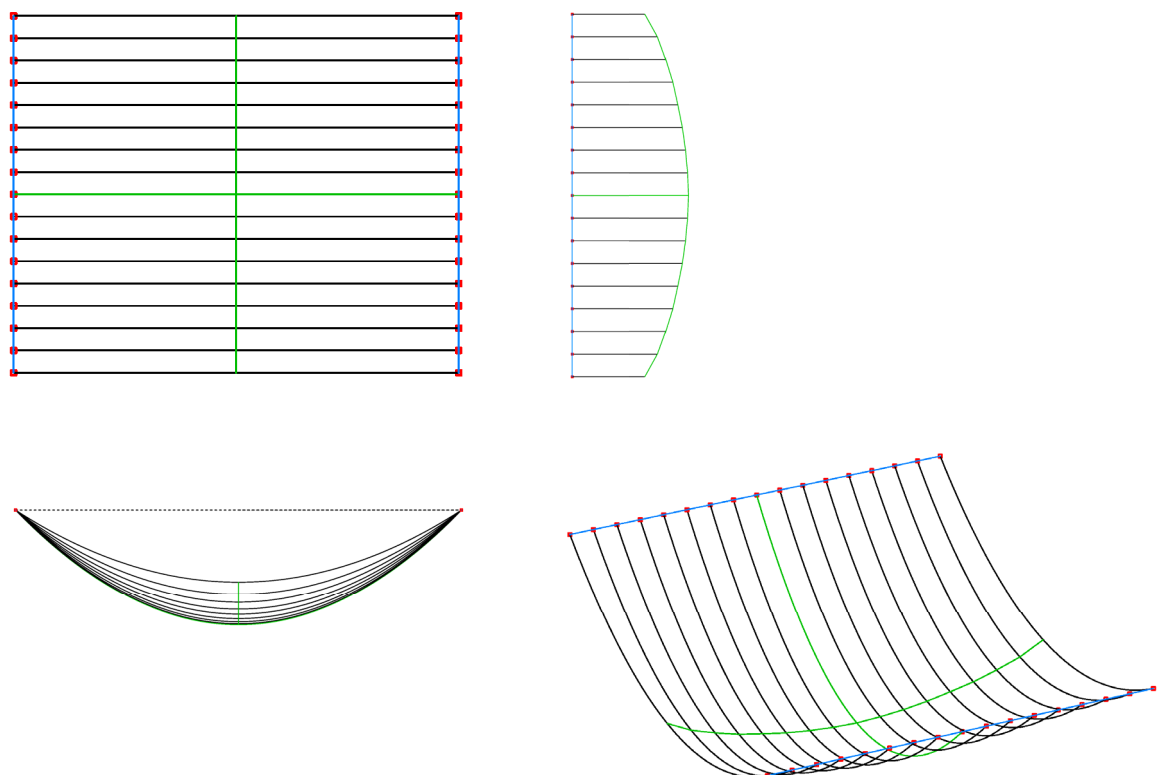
Modifikation B2: Draufsicht mit Quer- und Längsansicht und Isometrie
